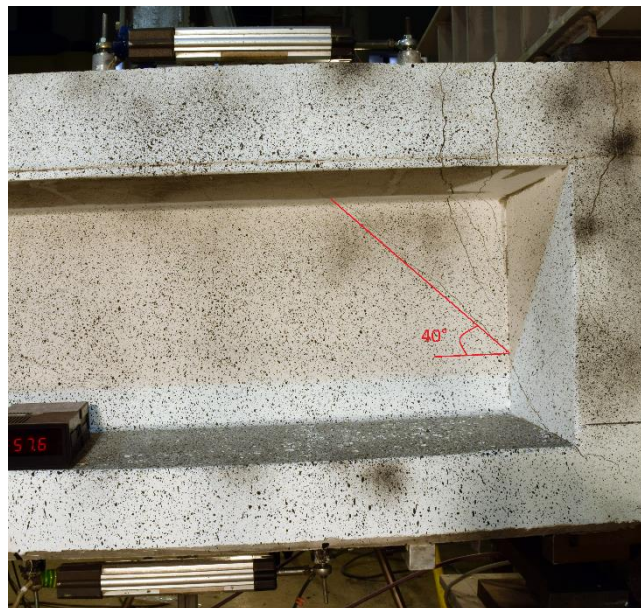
Ángulo de fisuración en la viga 2
